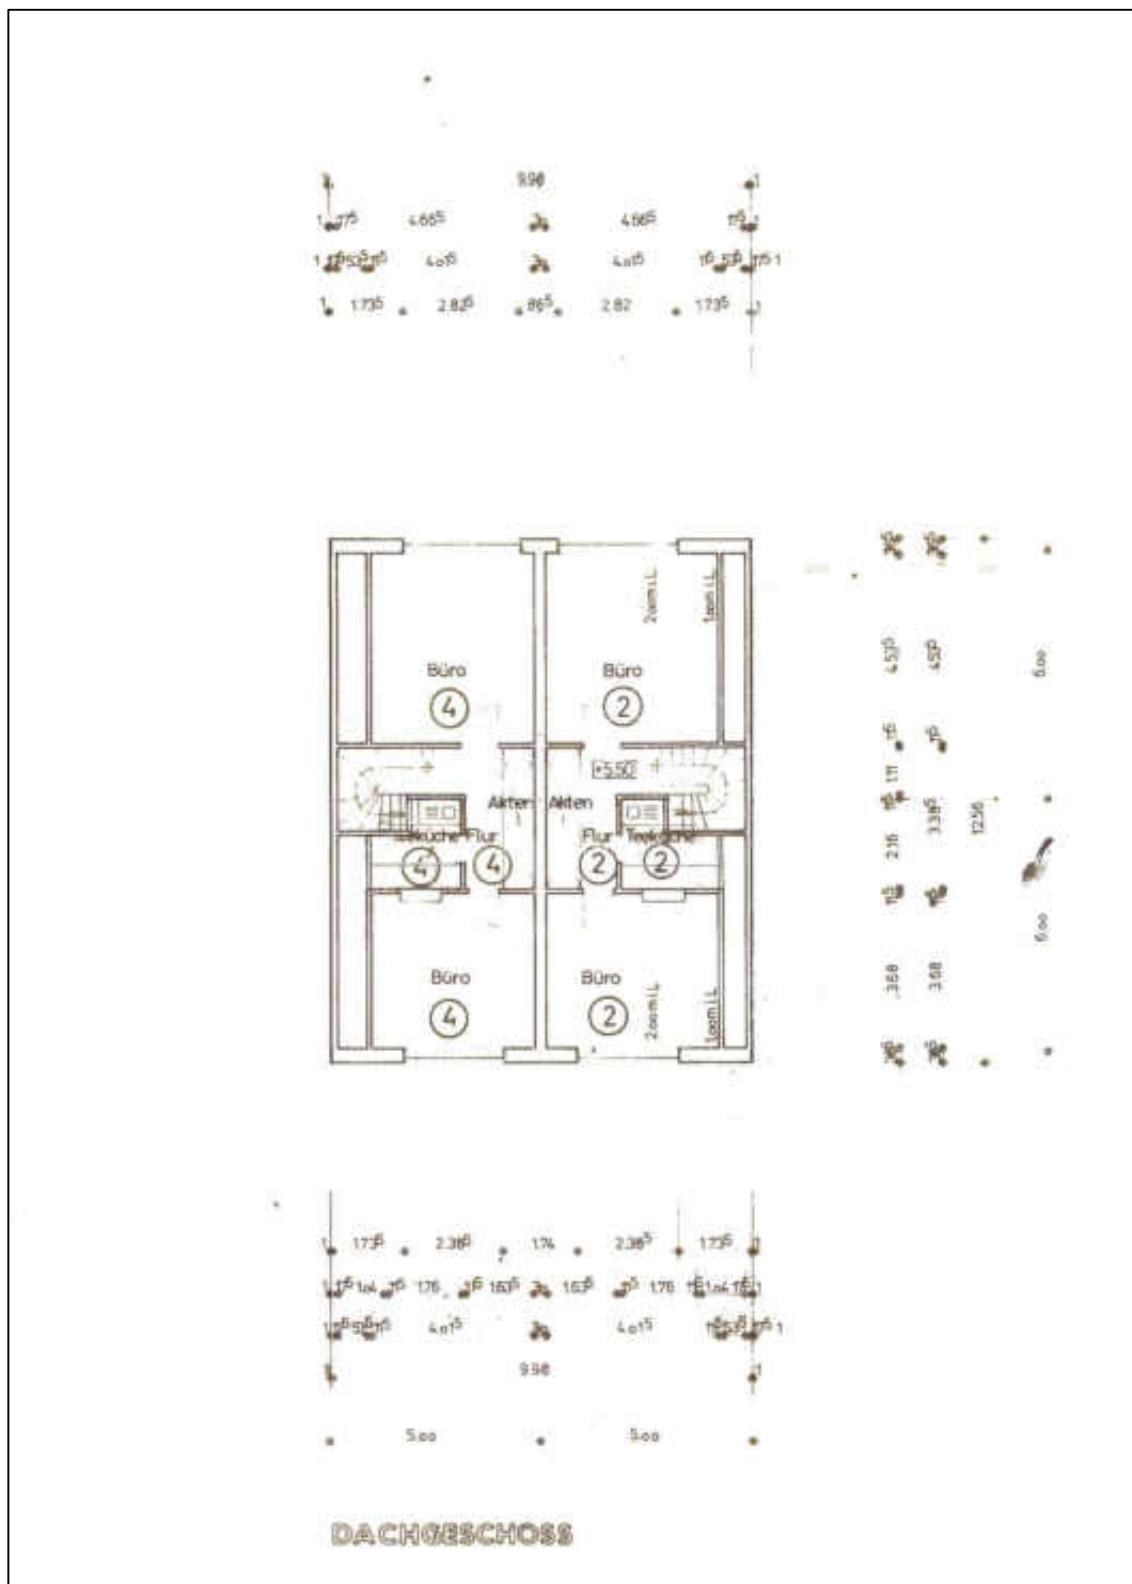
Grundriss vom Dachgeschoß Gebäudetyp E
